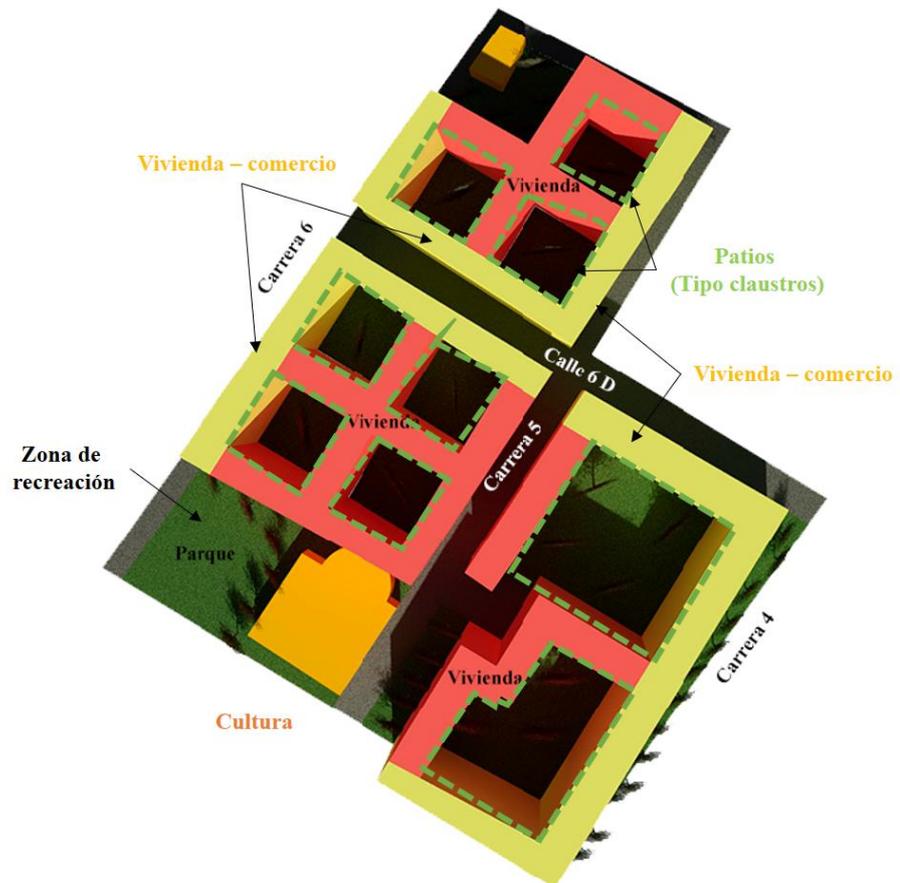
Plot plan del Conjunto Habitacional Santa Fe
